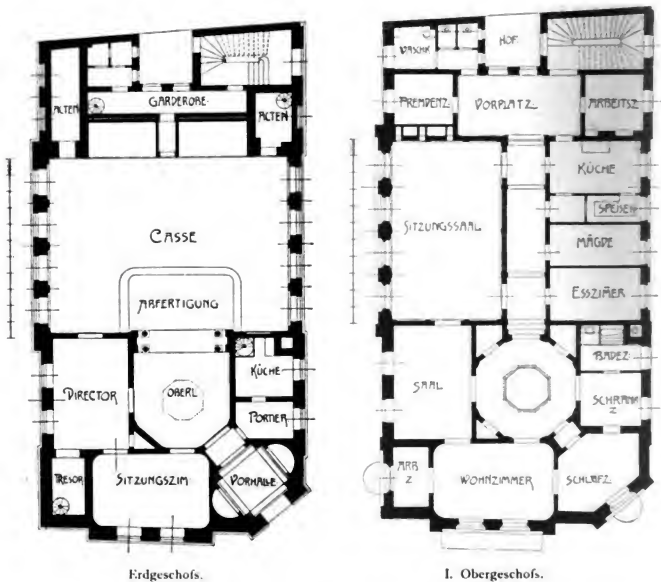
und 380. Grundrisse der beiden Hauptgeschosse.
